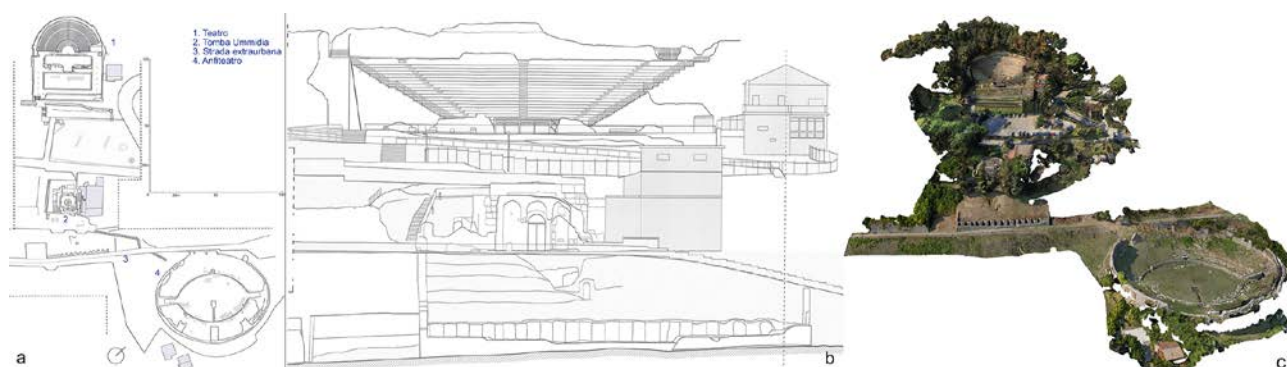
Area archeologica rilevata, elaborazioni grafiche-digitali. a. Planimetria generale, b. Prospetto da valle, in primo piano le sostruzioni tangenti alla strada extraurbana, al centro la tomba e in alto il teatro, c. Vista aerea dell'area da mesh unica, prodotta dall'elaborazione e integrazione dei molteplici dati acquisiti.
